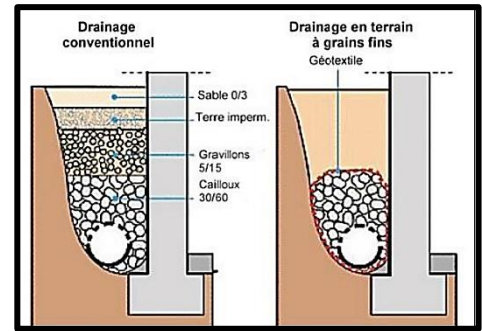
Modèle et drainage d'un mur de soutènement Source : <https://travauxbeton.fr/mur-soutenement/>
